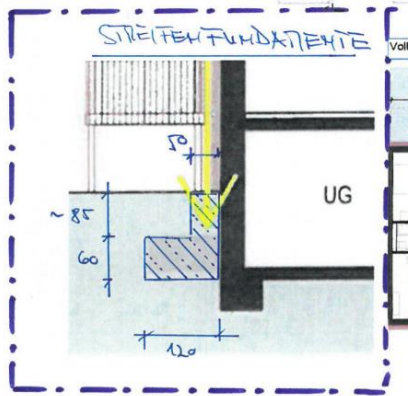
Fundamentierung, Sailer Stepan Tragwerksteam
